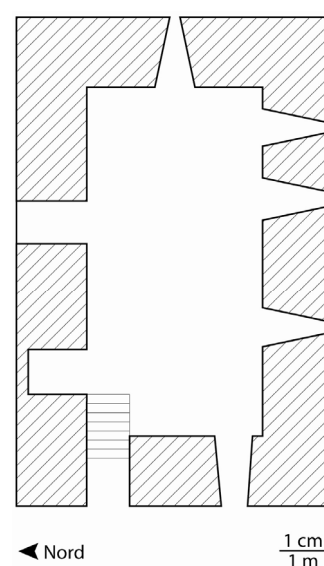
Plan XIX<sup>e</sup> siècle : on ouvre une fenêtre dans le mur ouest au niveau de la corniche, on obstrue la porte du mur nord. On y accède par des escaliers car le niveau du sol de la chapelle a baissé.
